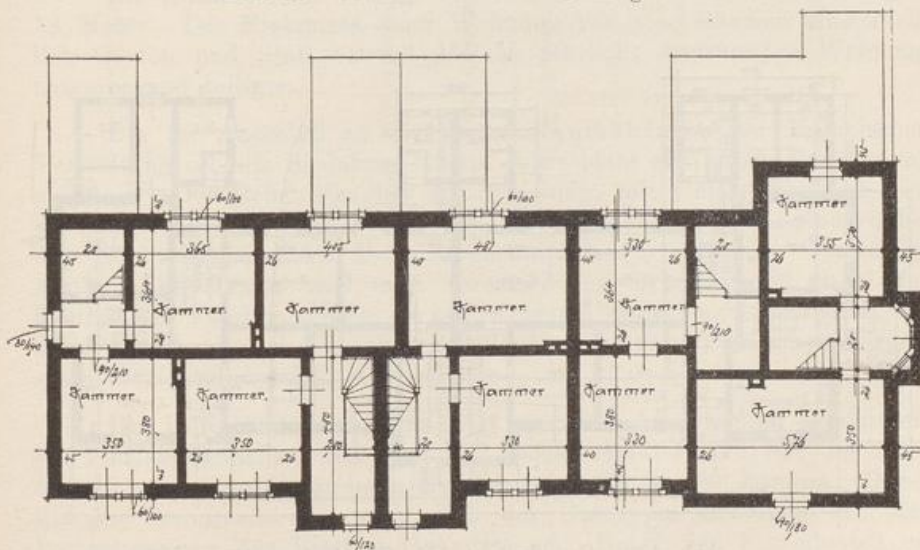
Grundriß zu Abb. 94. Dachgeschoß.
